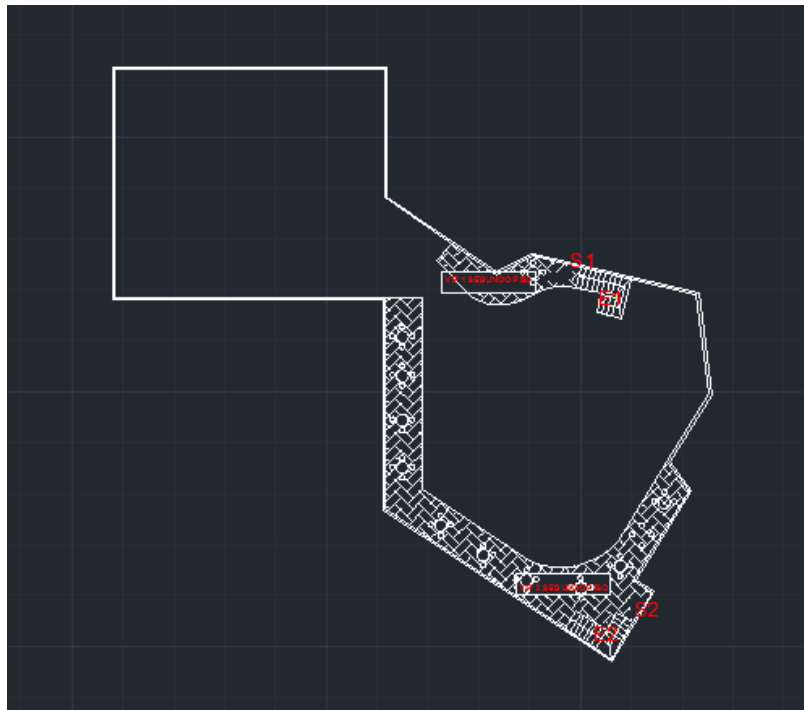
“Plano de la planta del primer piso de la discoteca 1 en formato DXF.”
